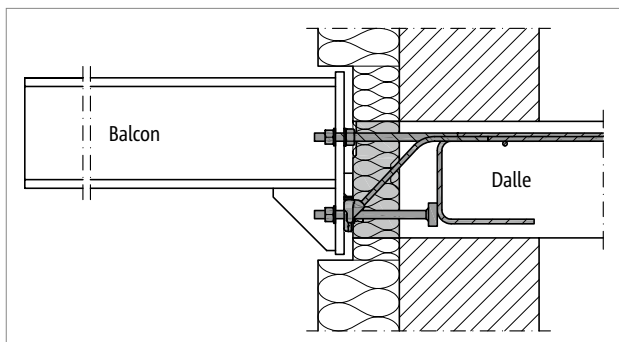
Schöck Isokorb® T type SK : passage sans obstacle grâce au décalage en hauteur
